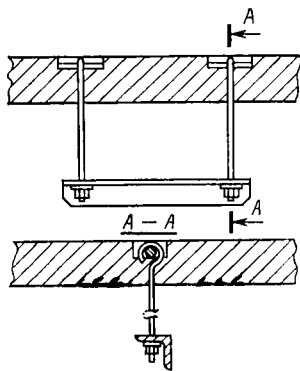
Подвески для прокладки кабелей под перекрытием.
